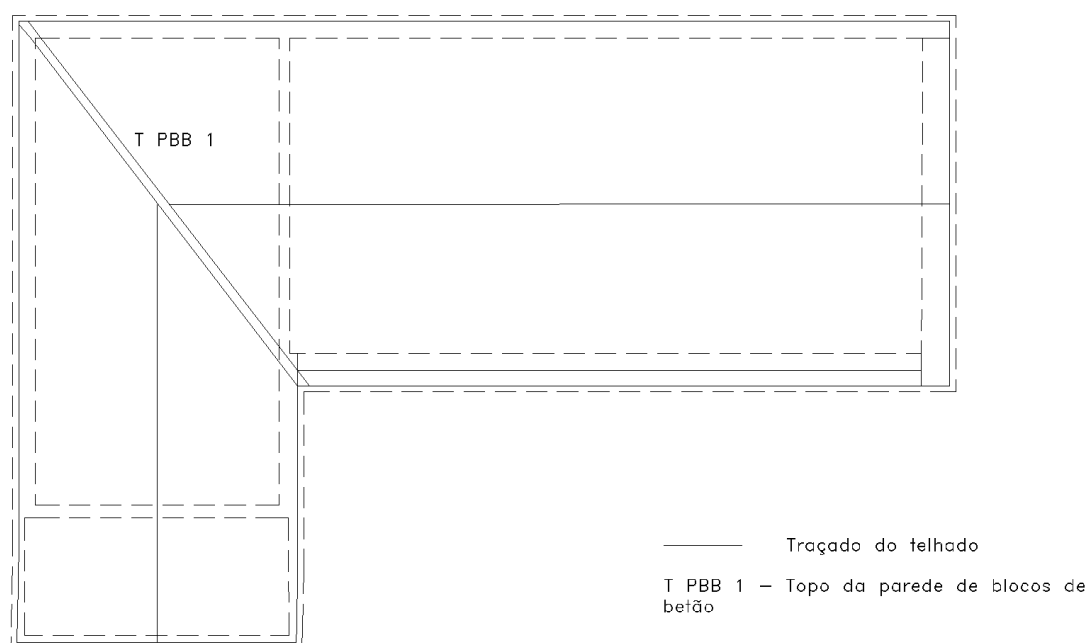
Planta com o traçado proposto para a cobertura.
